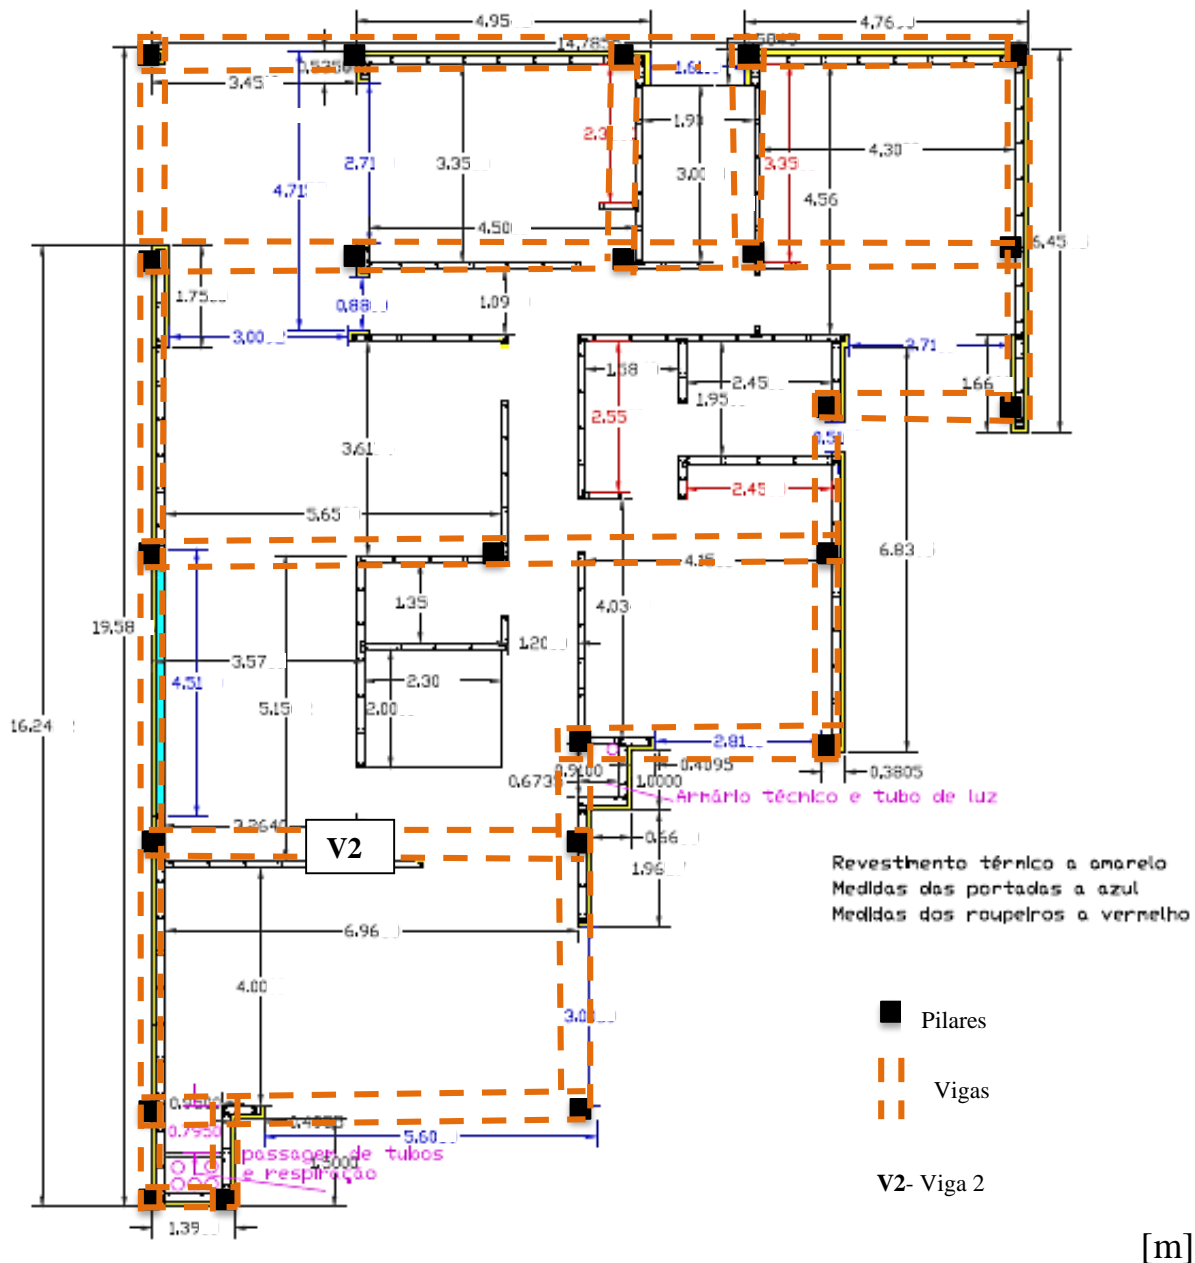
Esboço da disposição dos pilares e vigas que foram adotadas na análise orçamental da solução corrente de alvenaria e B.A. para a obra da Ponta do Sol
